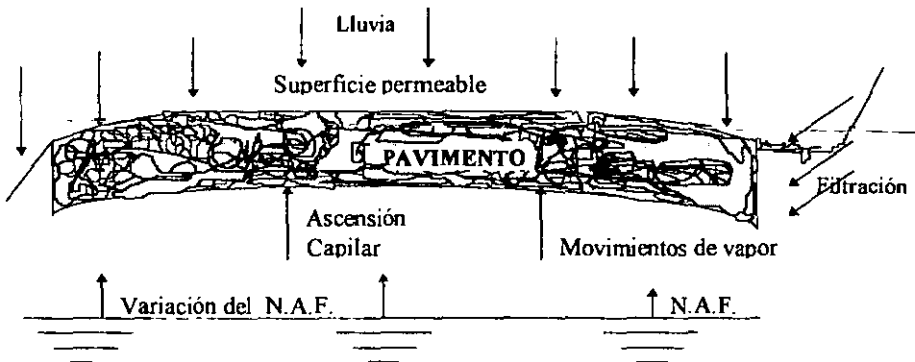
Formas en que el agua puede entrar a la estructura del pavimento
